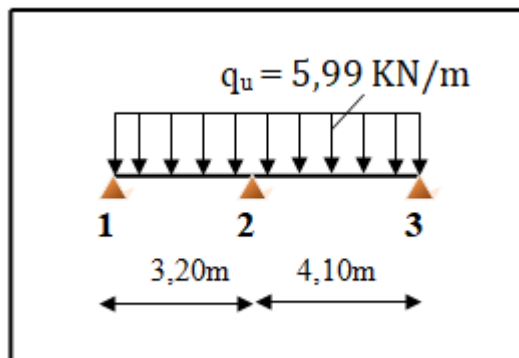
schéma statique des poutrelles à l'ELU (3^{ème} cas).
